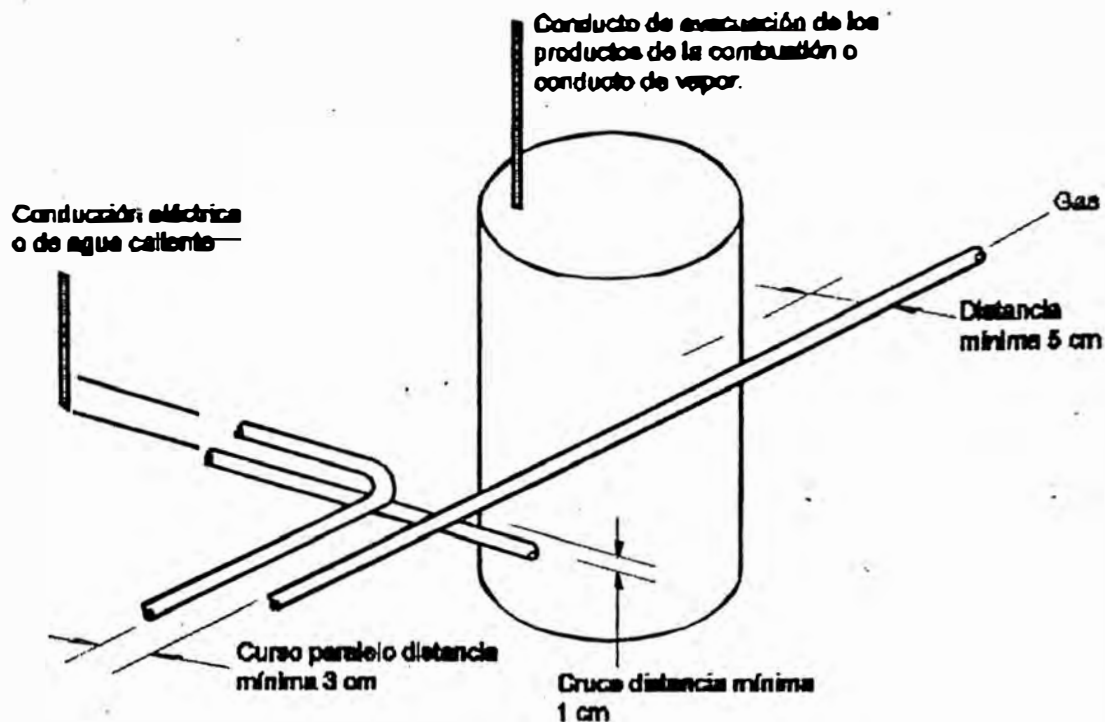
Tuberías que conducen gas instaladas a la vista o embebidas y tubería de otros servicios
